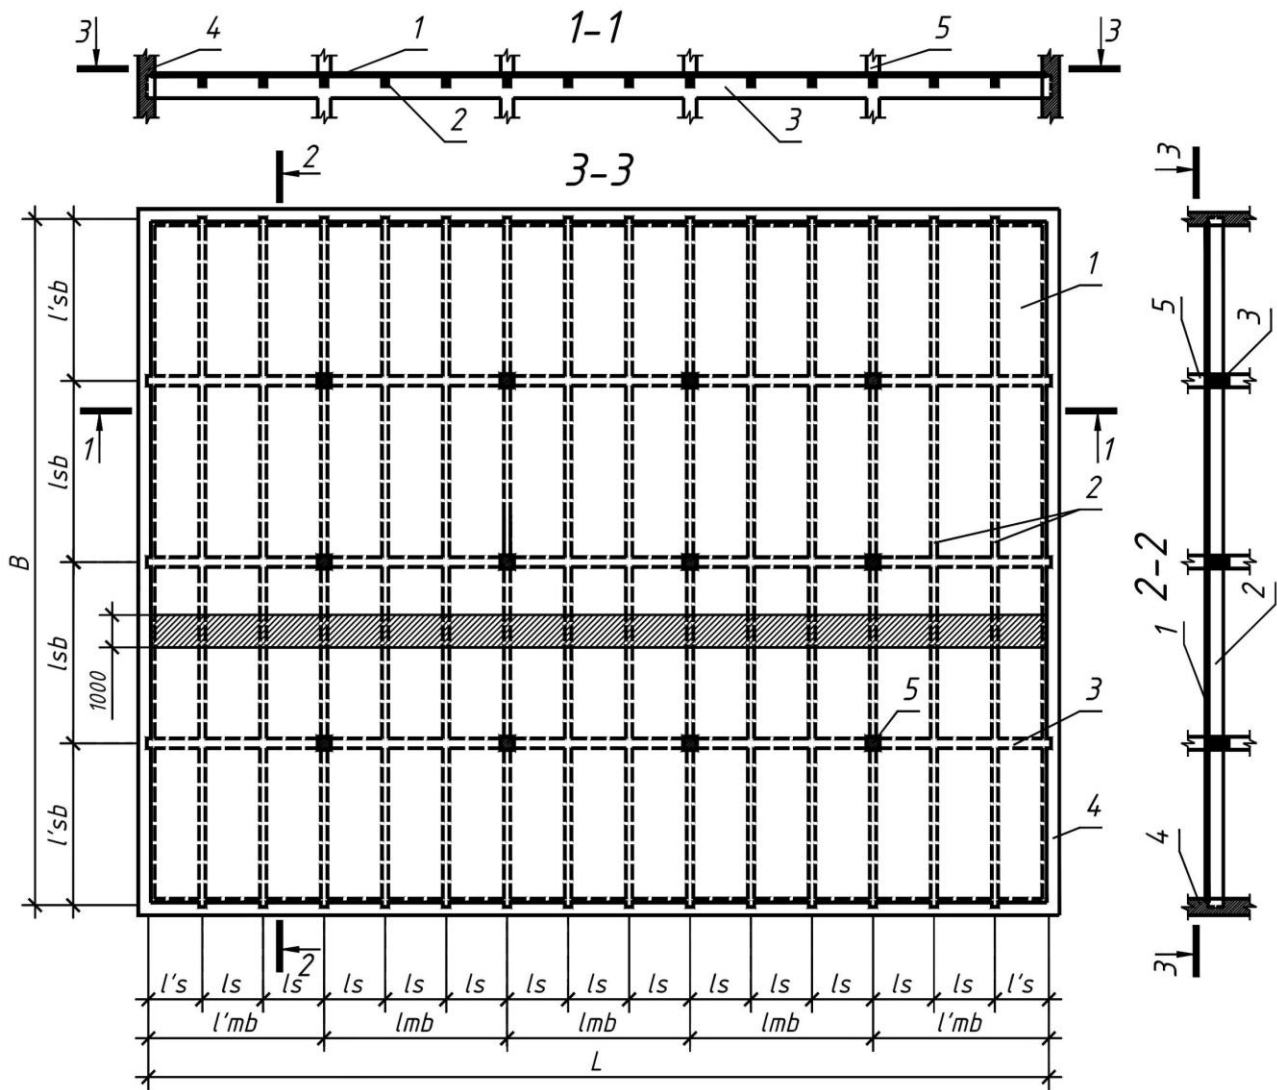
План монолітного ребристого перекриття з головними балками вздовж будівлі: 1 – плита; 2 – другорядна балка; 3 – головна балка; 4 – стіна; 5 – колона
